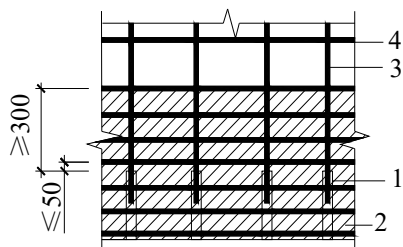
钢筋套筒灌浆连接部位水平分布钢筋的加密构造示意
